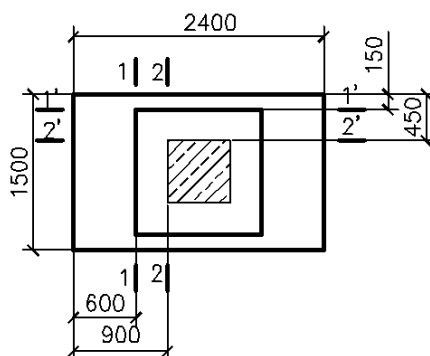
Схема к расчету арматуры плитной части фундамента
